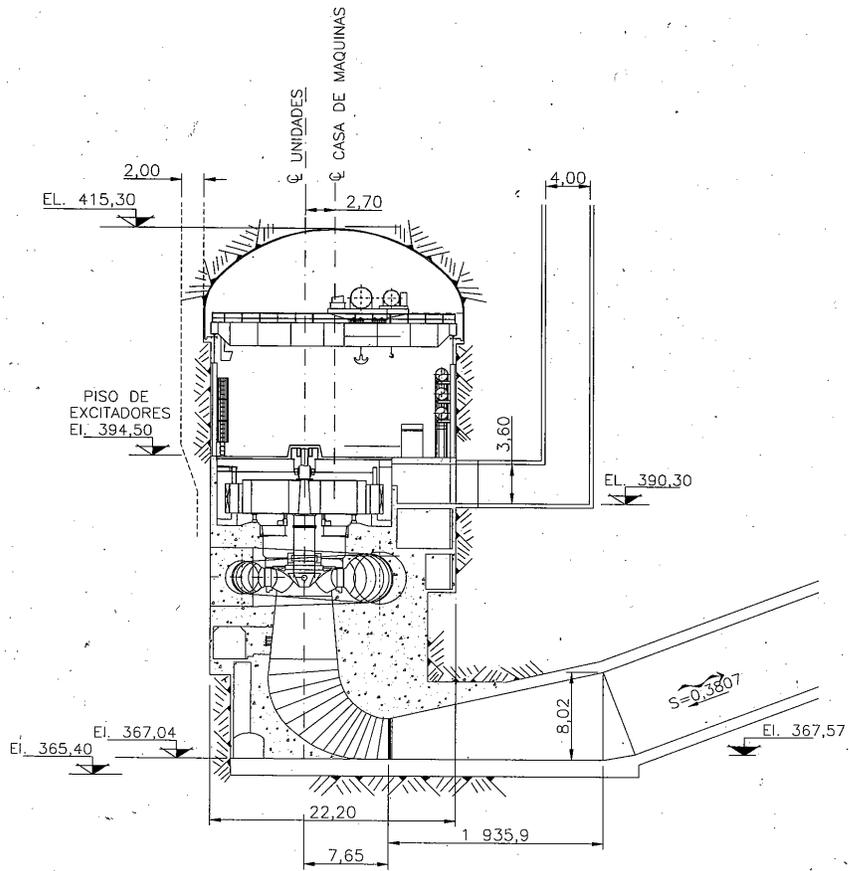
Corte transversal de la caverna de casa de máquinas
